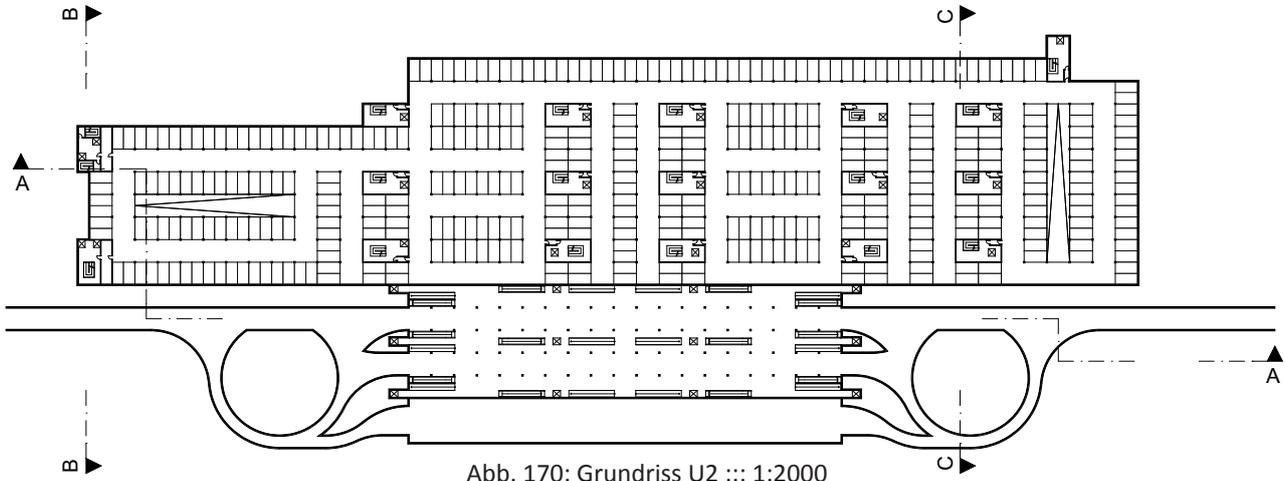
Grundriss U2 ::: 1:2000
